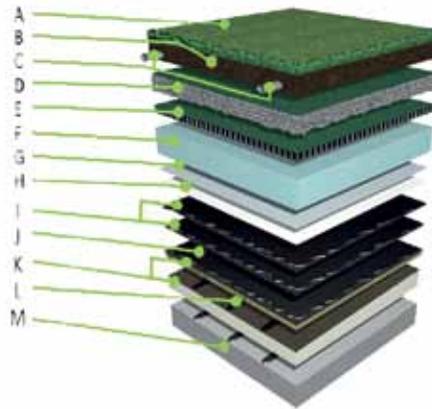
Ejemplo de cubierta vegetal Intensiva sobre hormigón. (Gentileza Tremco Roofing.)
